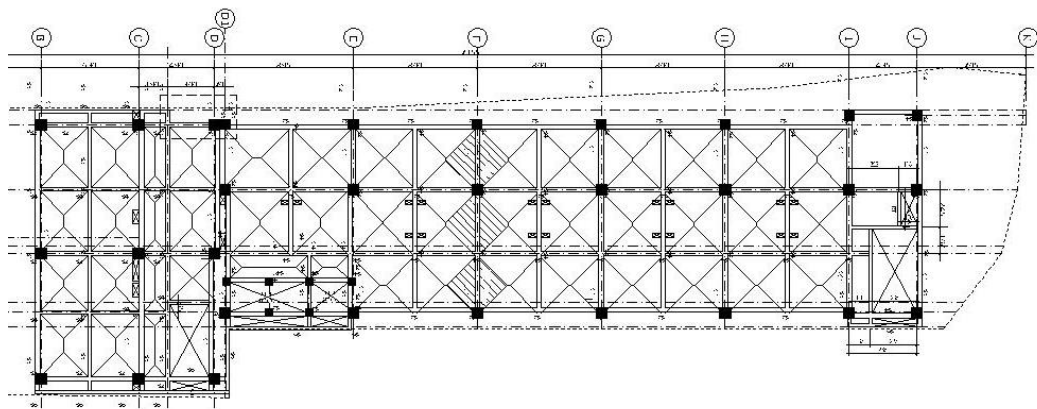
Denah Potongan Portal As 3 Arah X
